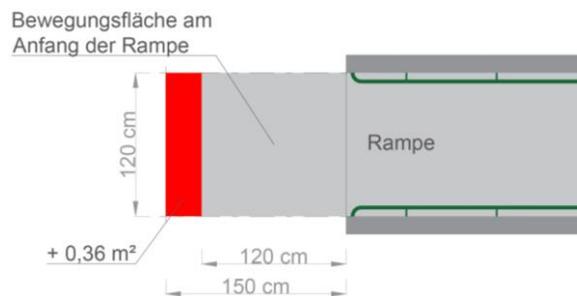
Horizontale Bewegungsfläche vor und nach Rampen
